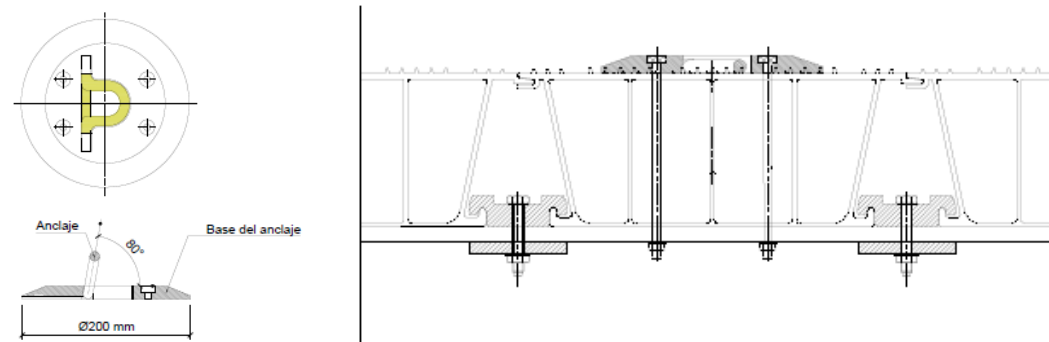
Punto de amarre en panel de aluminio del tablero. Fuente: Propia.
